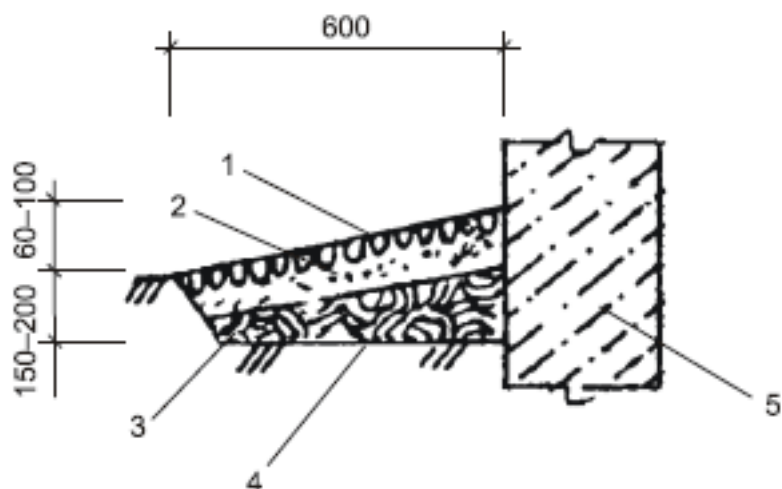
Деталь булыжной отсыпки: 1 – булыжник; 2 – подсыпка из среднезернистого песка; 3 – жирная мятая глина; 4 – уплотненный грунт; 5 – фундамент ленточный либо заборка из бетона, кирпича
